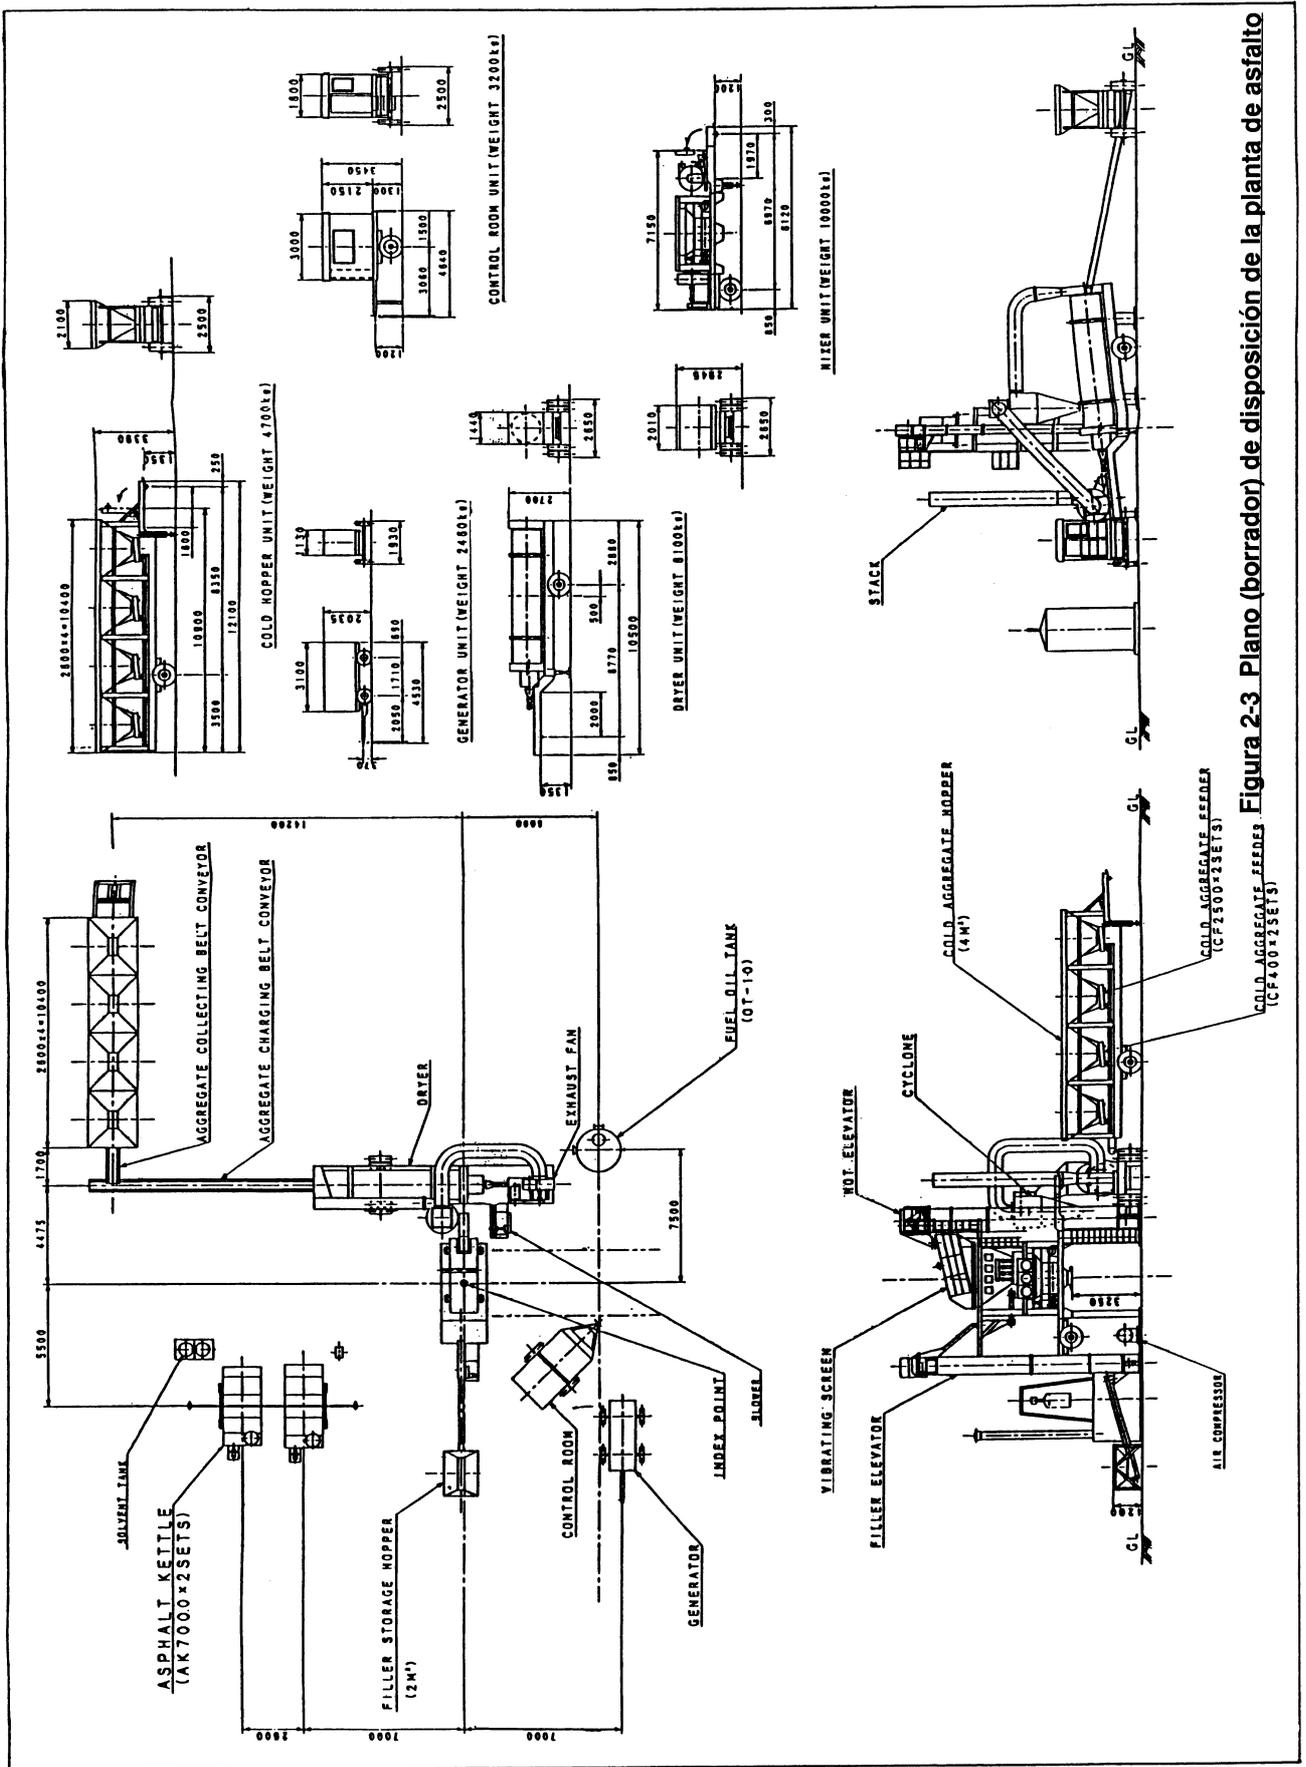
Plano (borrador) de disposición de la planta de asfalto
